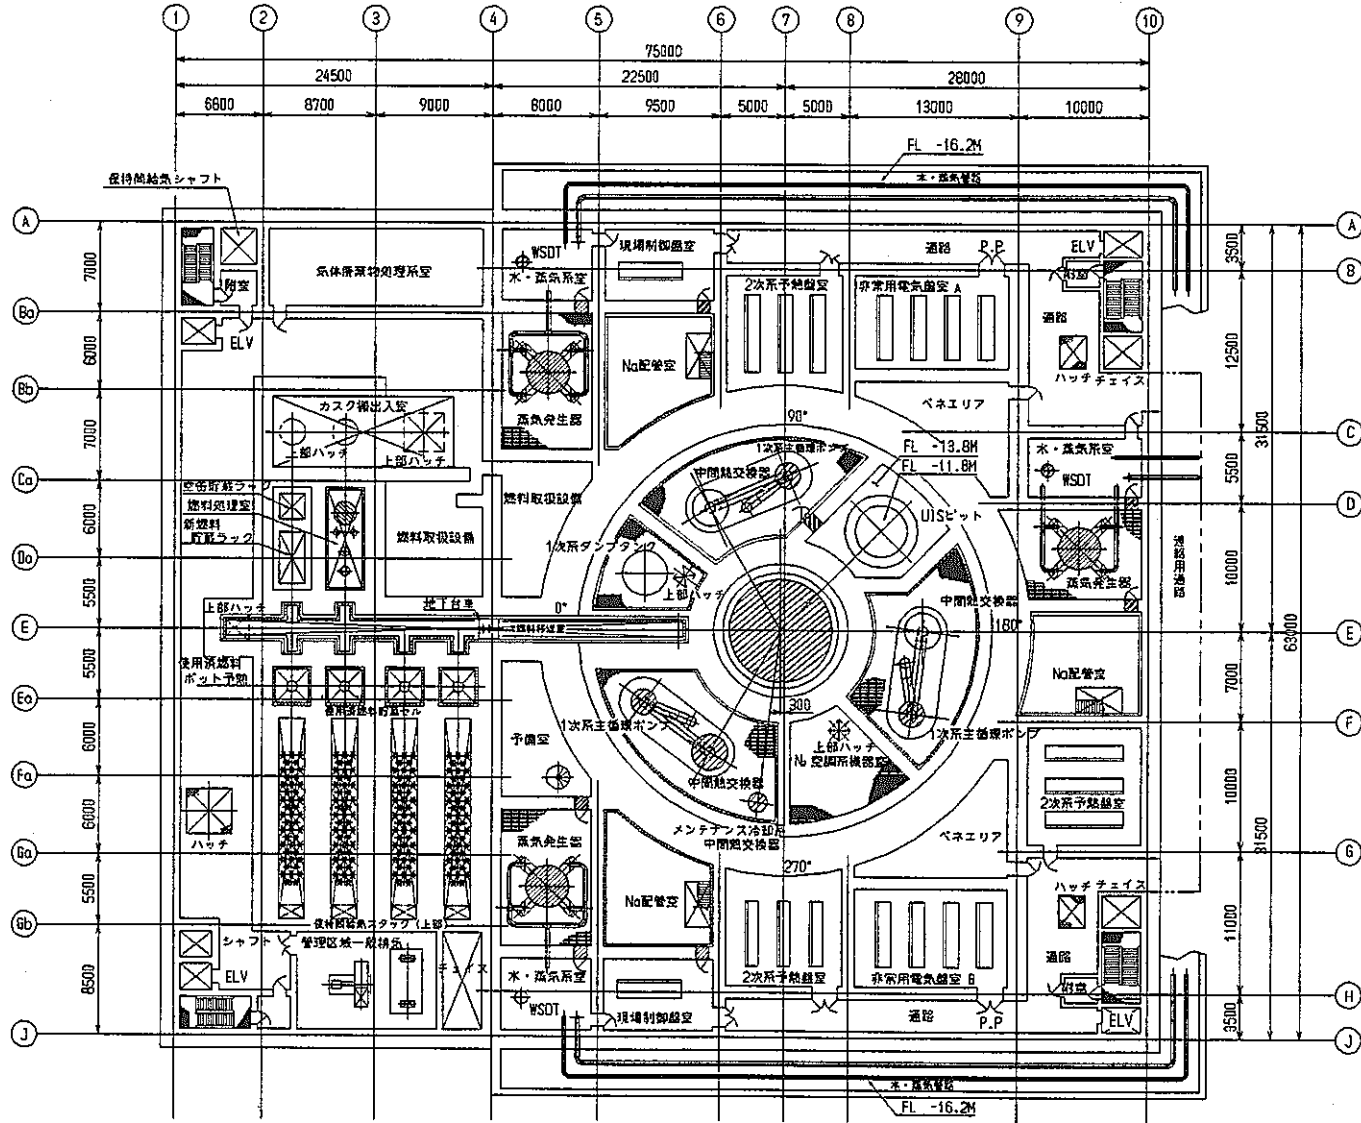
原子炉施設全体機器配置図 (FL-13.0 M (B2 F))
